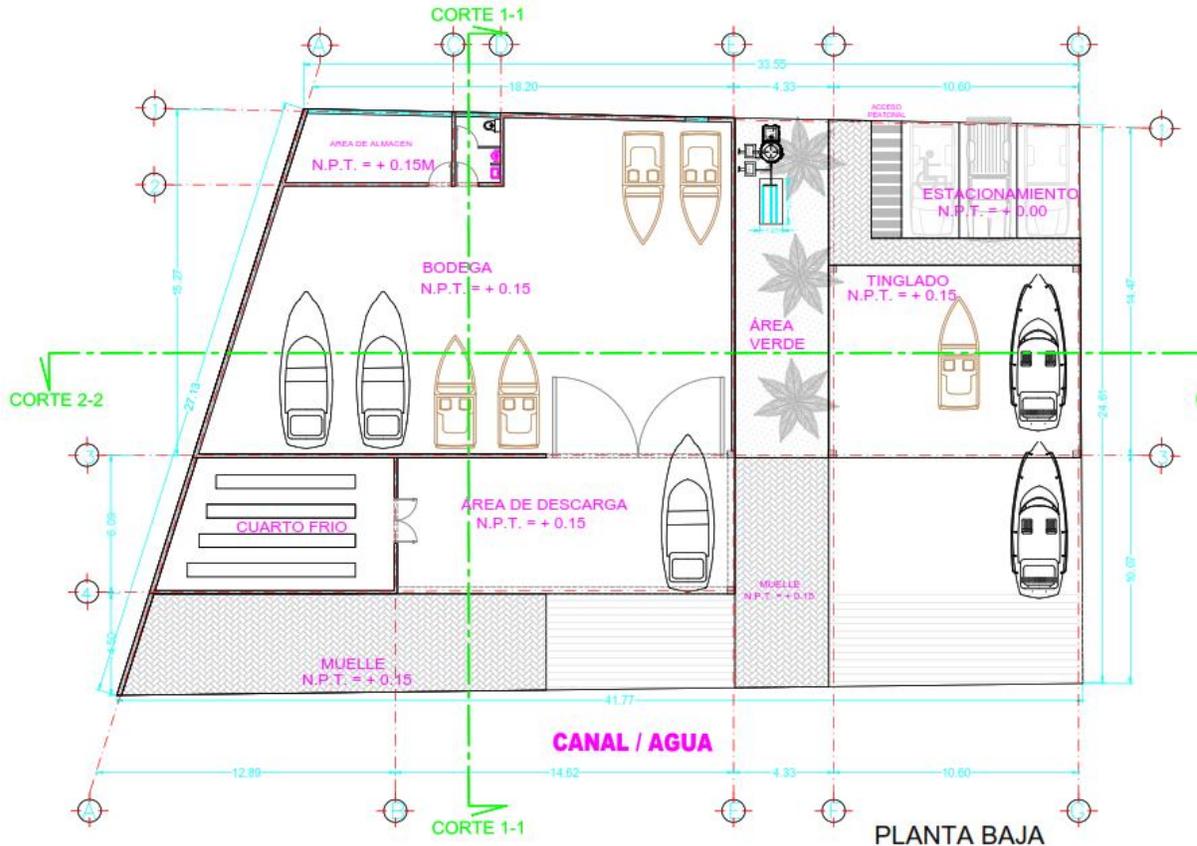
Plano general de conjunto de los conceptos de obra que se pretenden construir.
